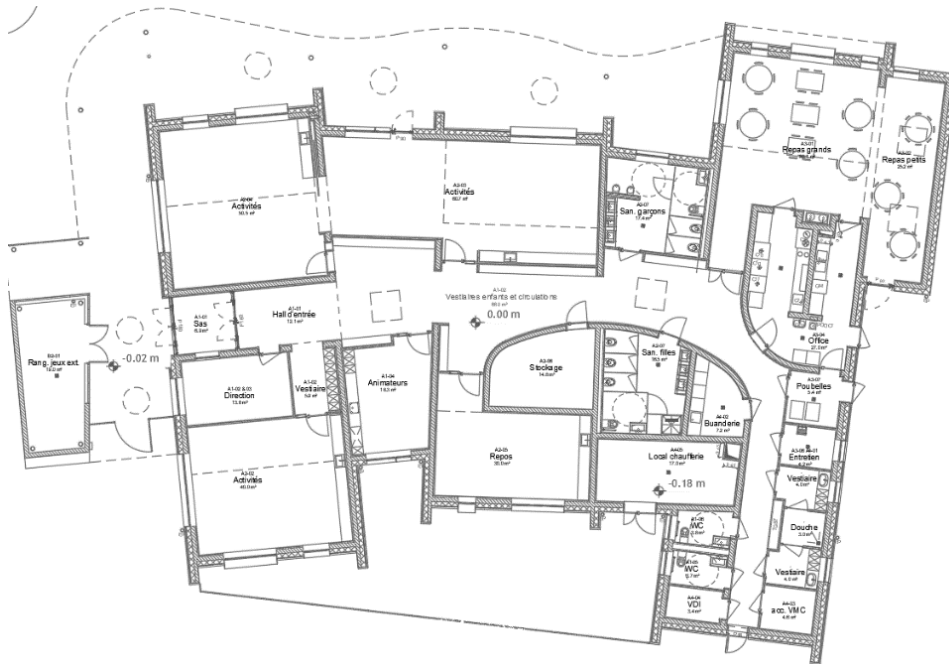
Périscolaire d'Elsenheim, vue en plan du rez-de-chaussée
